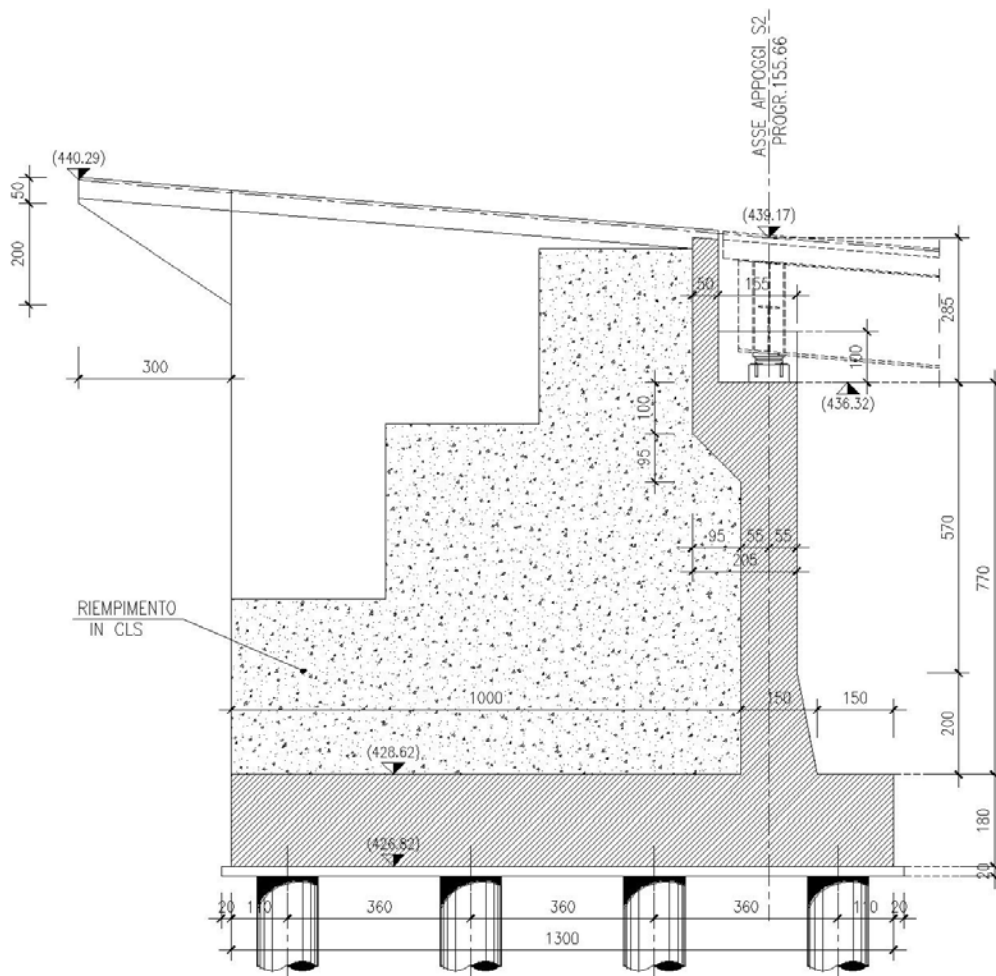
Sezione longitudinale della spalla 1.
